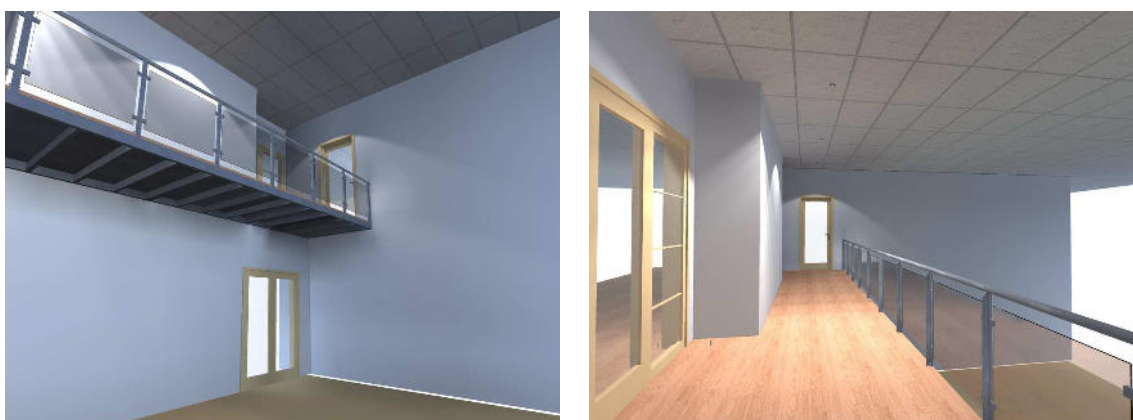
Vistas 3D, proposta inicial da zona da varanda, pé-direito duplo – “Ninho de empresas”
